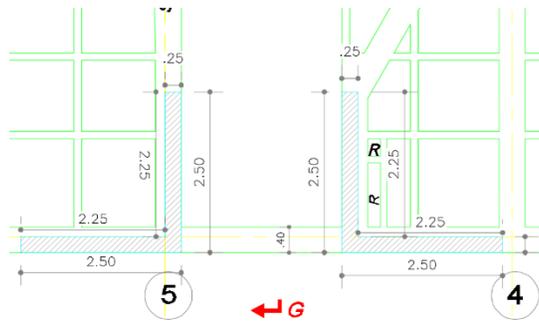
Vista parcial del plano de pantallas del segundo piso entre los ejes H-G entre 4-5.
